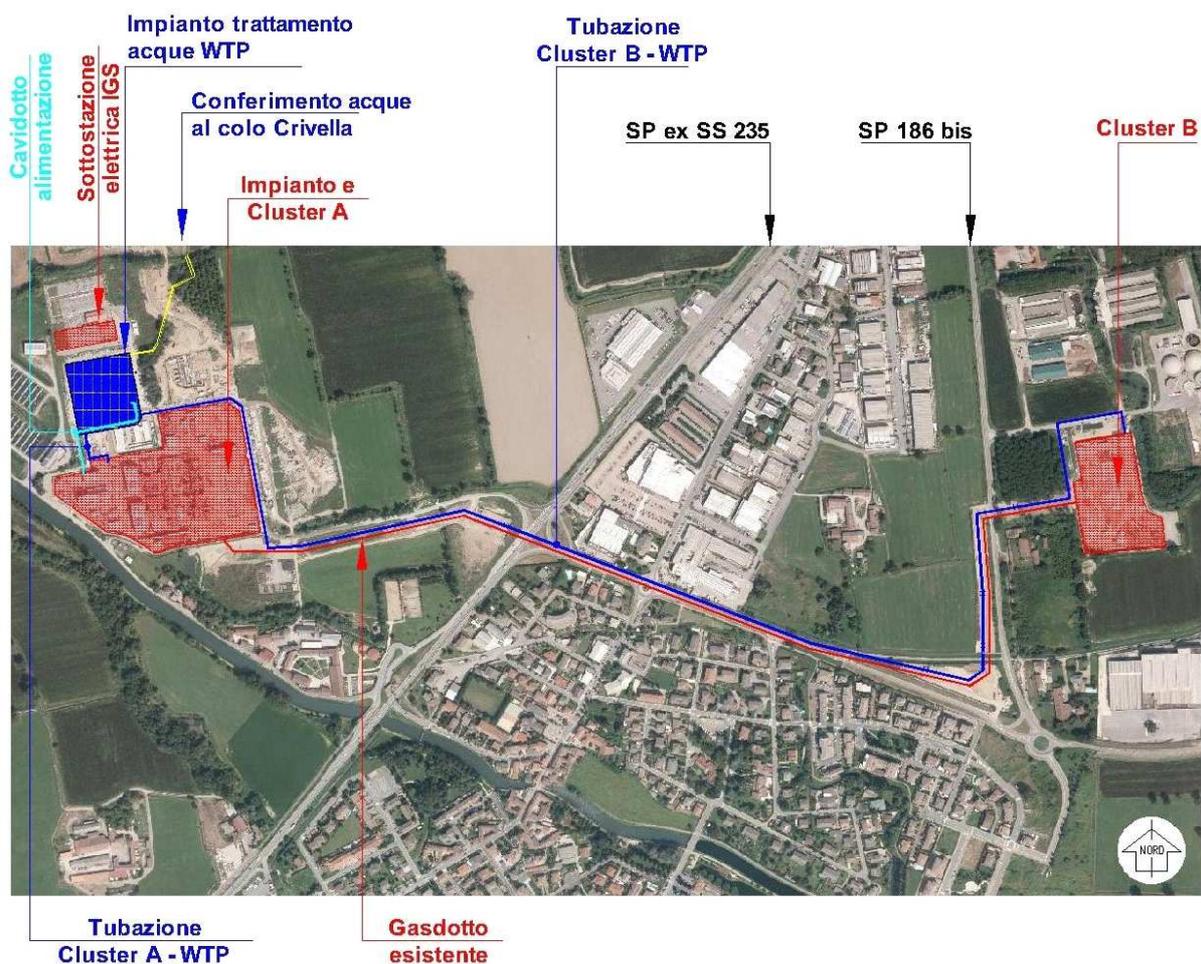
Localizzazione dell'impianto e delle tubazioni esterne di collegamento
